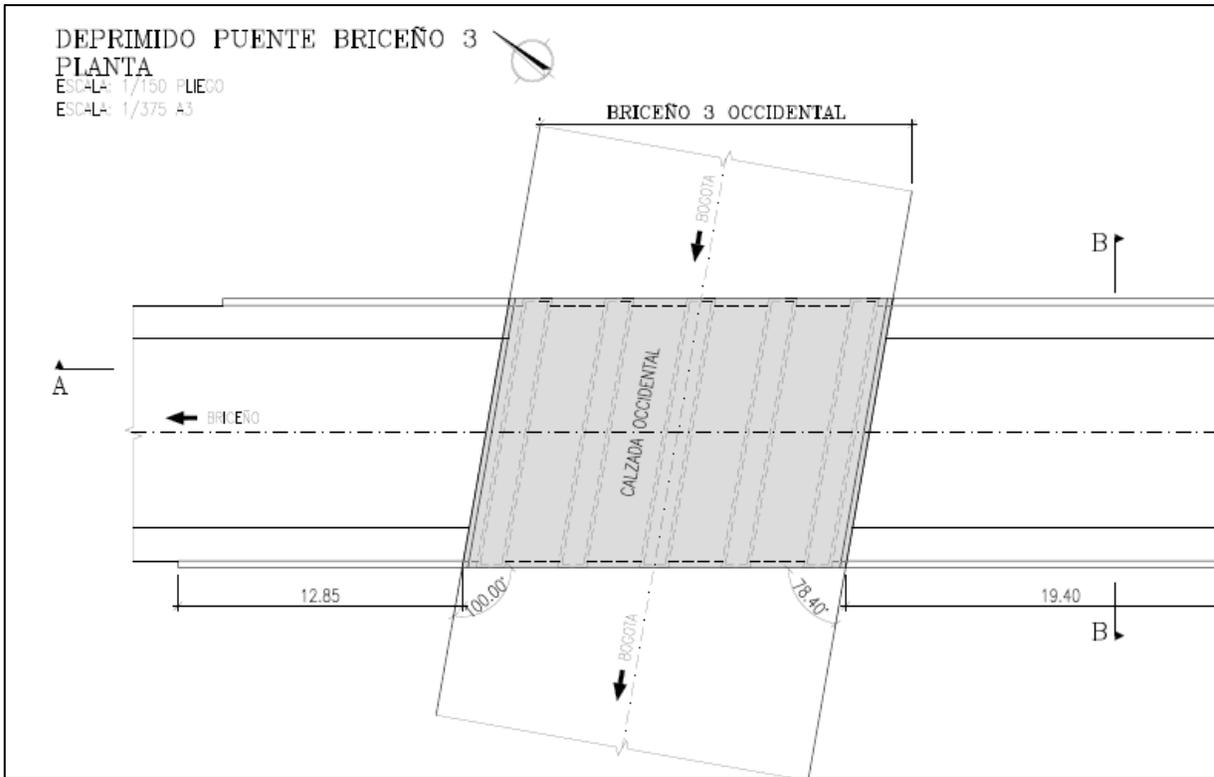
Vista en Planta Deprimido Briceño 3 Occidental
